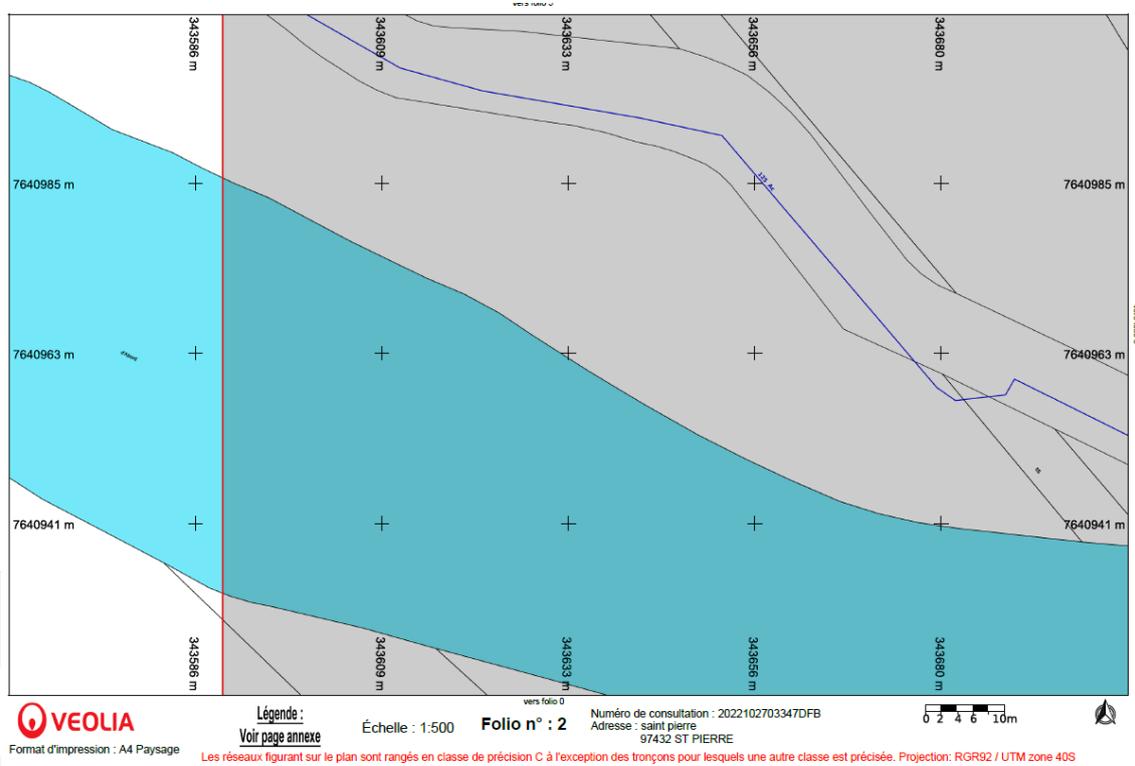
Plan de réseau transmis par Veolia – Zoom sur la zone Bras Central
